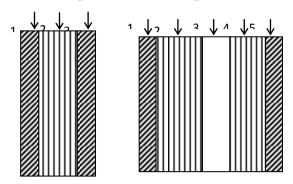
Coupe transversale d'un mur extérieur et intérieur
